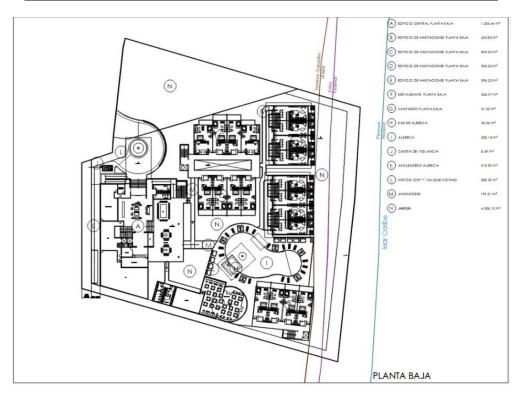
Plano arquitectónico de conjunto de la planta baja del proyecto.
